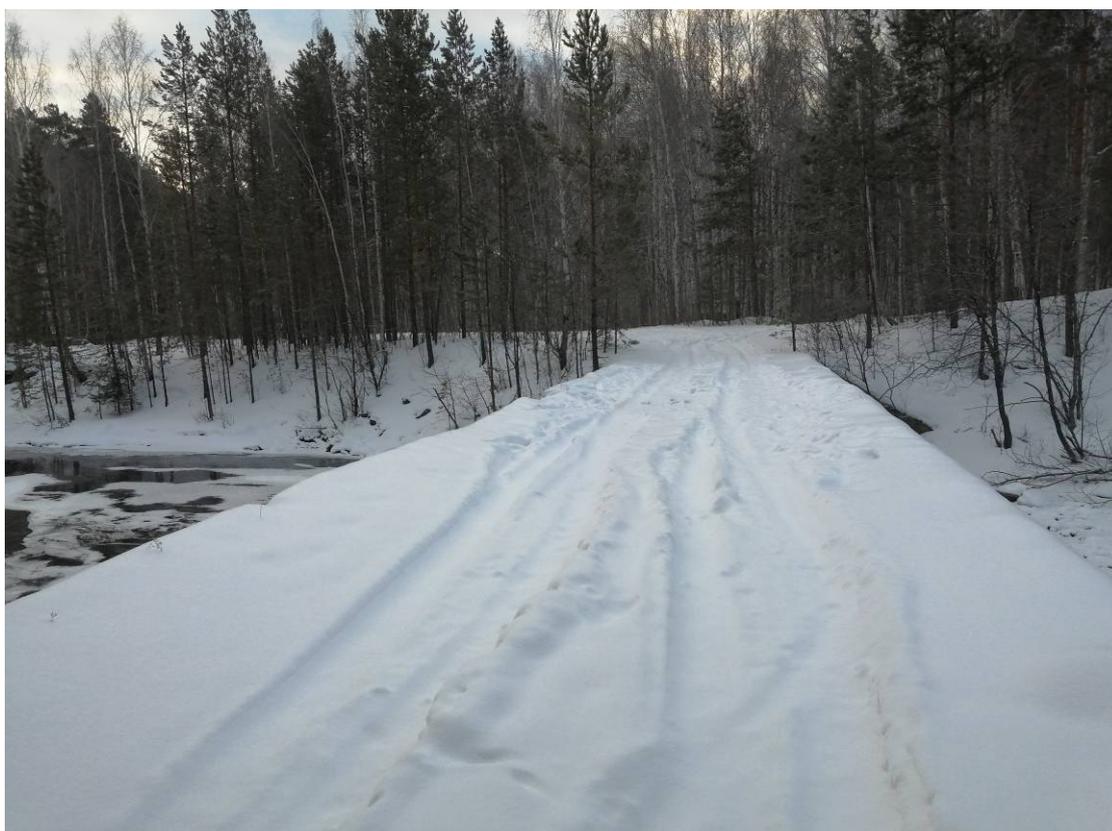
Бетонный мост через Большой Киалим ниже водохранилища
